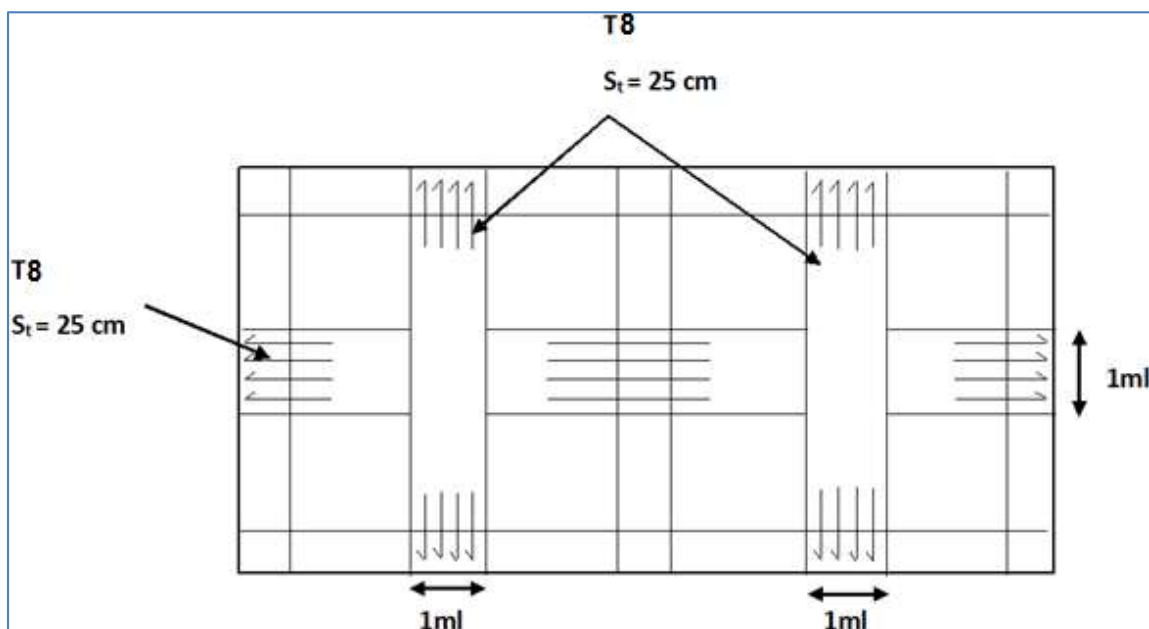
Nappe supérieure du ferrailage de la rampe d'accès
